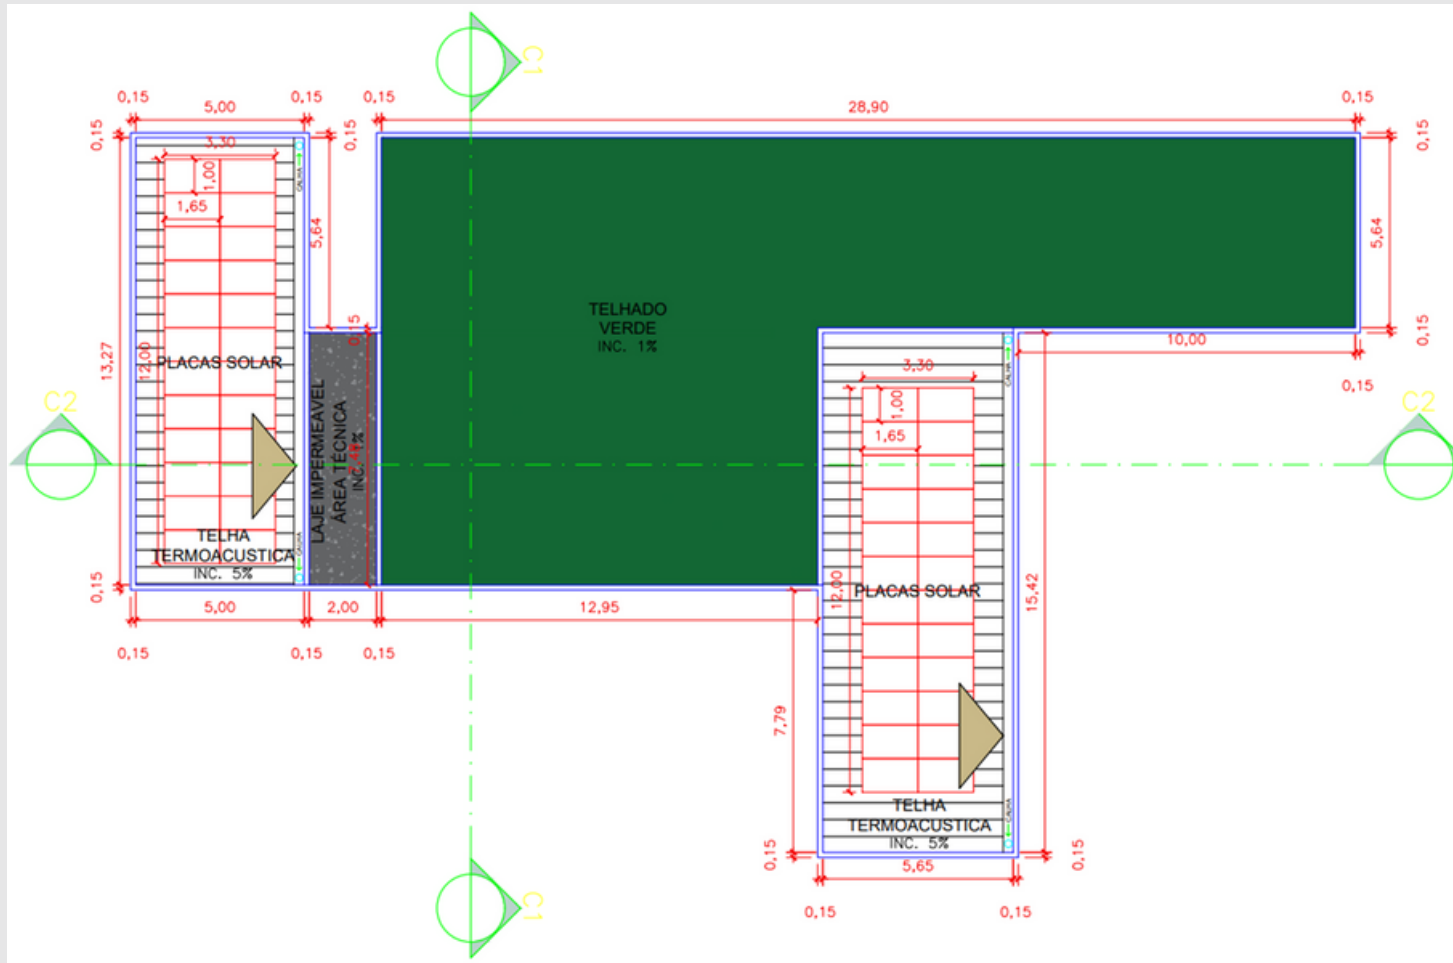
Planta de cobertura doca e planta de cobertura lavanderia
